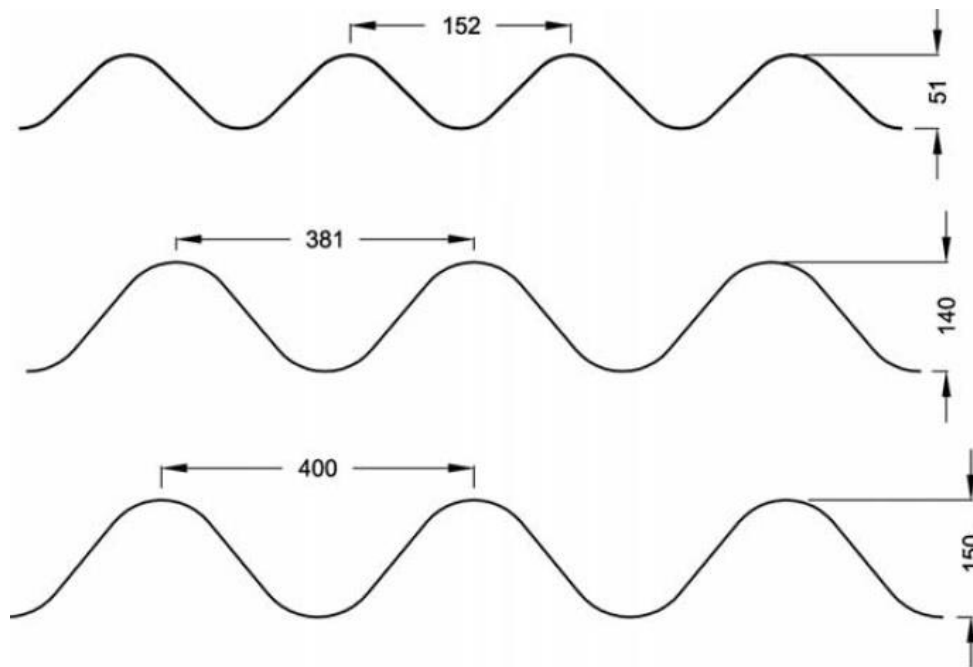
Perfiles de corrugación del acero 152x51mm, 381x140 mm y 400x150 mm. Fuente: Handbook of Steel Drainage & Highway Construction Products (2007)
